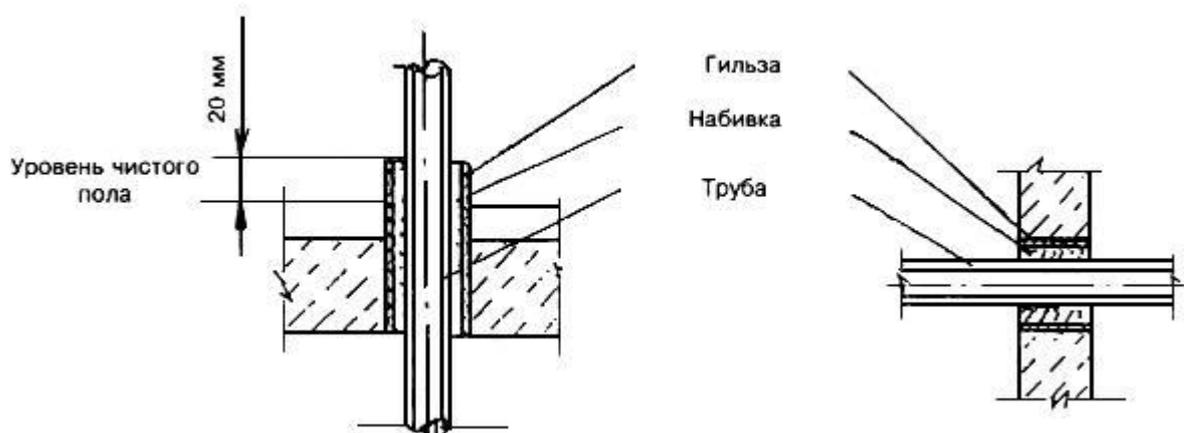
Установка гильзы для прокладки труб в стенах и перекрытиях
